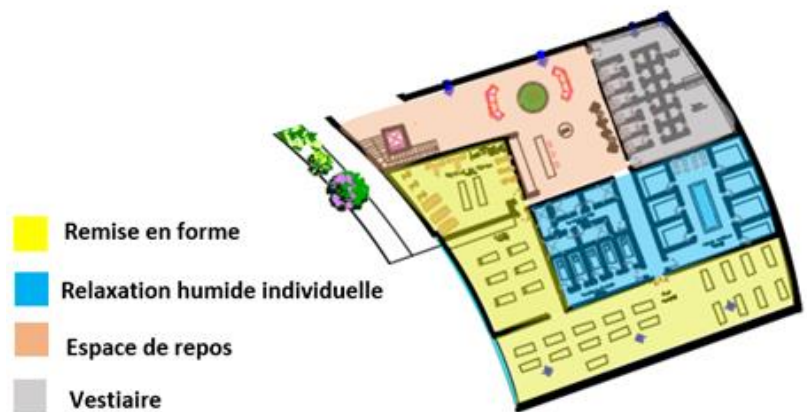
vue en plan sur l'entité bien être (niveau +7.36)
